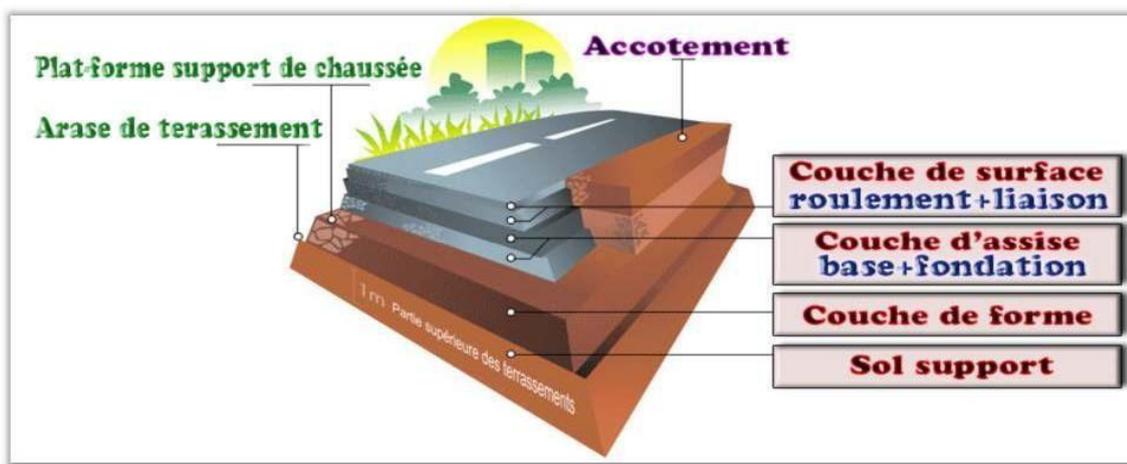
LES ELEMENTS DE LA CHAUSSEE
